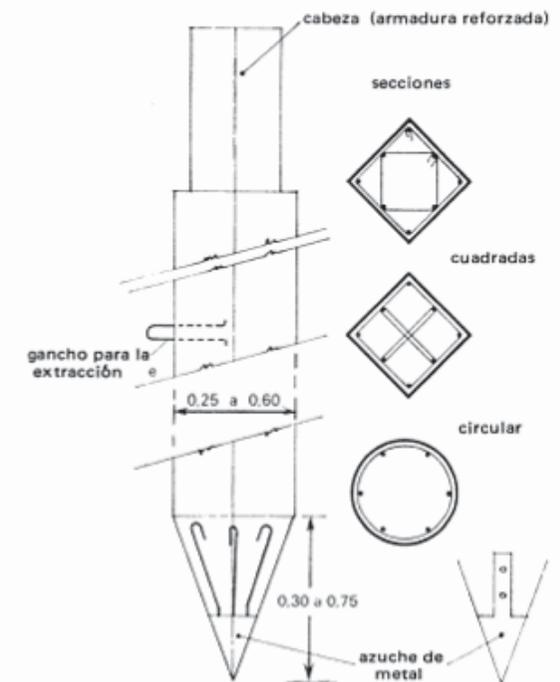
detalle pilote de hormigón armado. Enciclopedia de la construcción.
